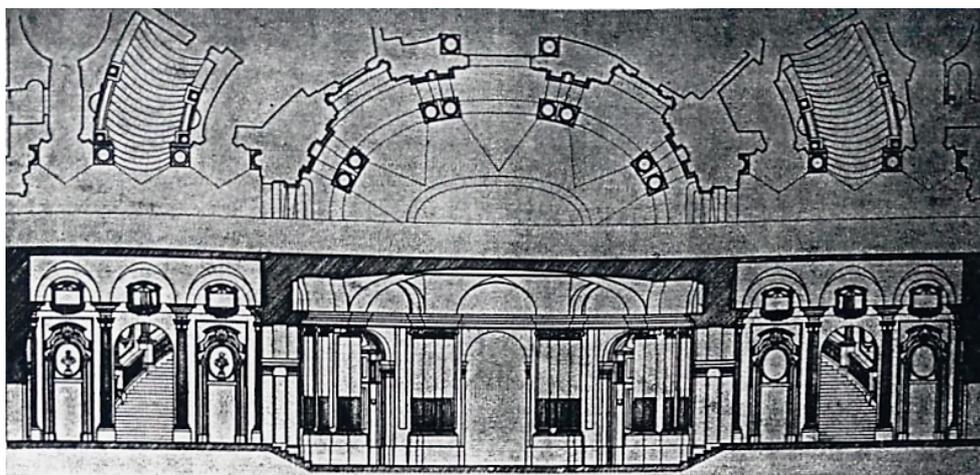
pianta e sezione dell'atrio e del doppio scalone d'onore Palazzo Carignano. (da Passanti, p. 23).
